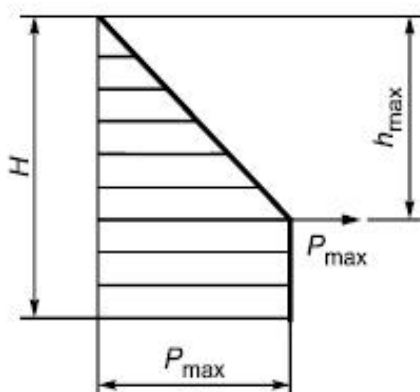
Расчетная эпюра бокового давления бетонной смеси при уплотнении смеси внутренними вибраторами
